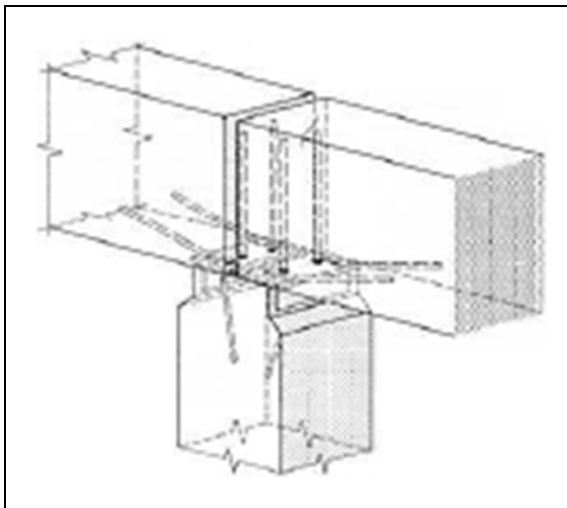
Ligação com placa de apoio (aço) (Stupré, 1981)
